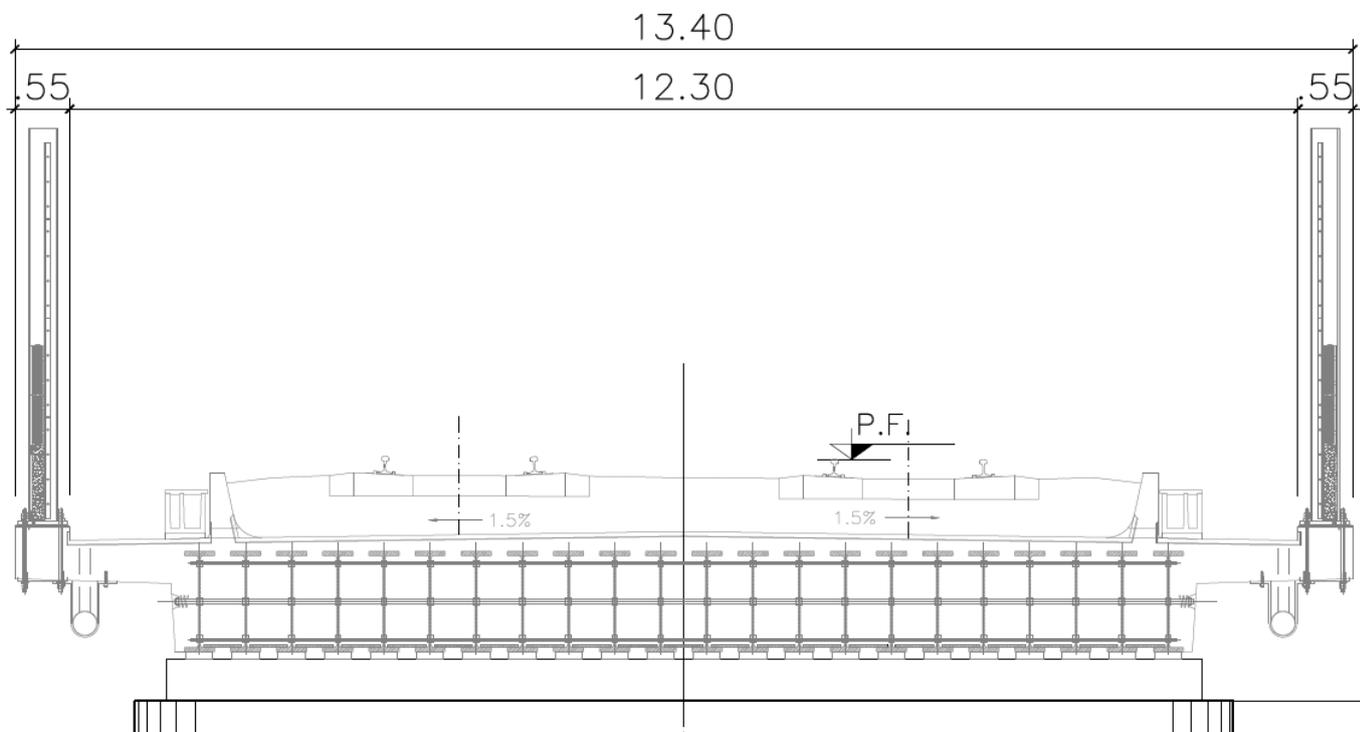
Sezione tipo - trasversale impalcato da 22 m con travi in acciaio incorporate.
